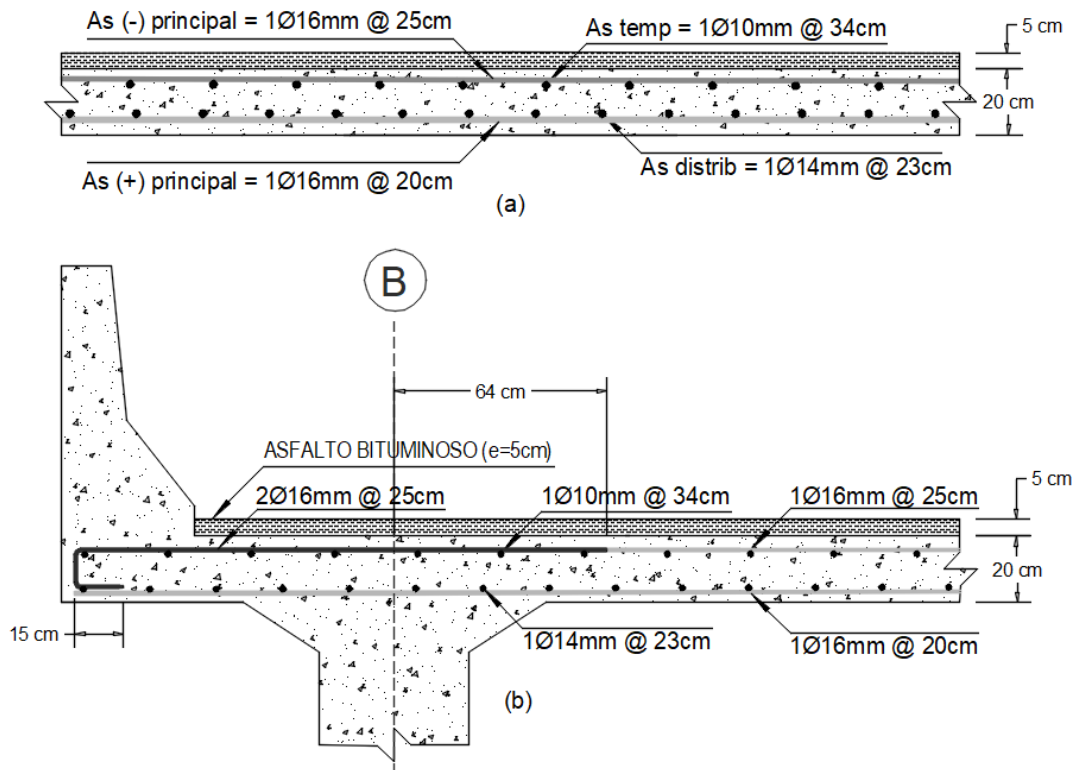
(a) Sección transversal de losa y (b) volado de losa en la variante de vigas de hormigón postensado
